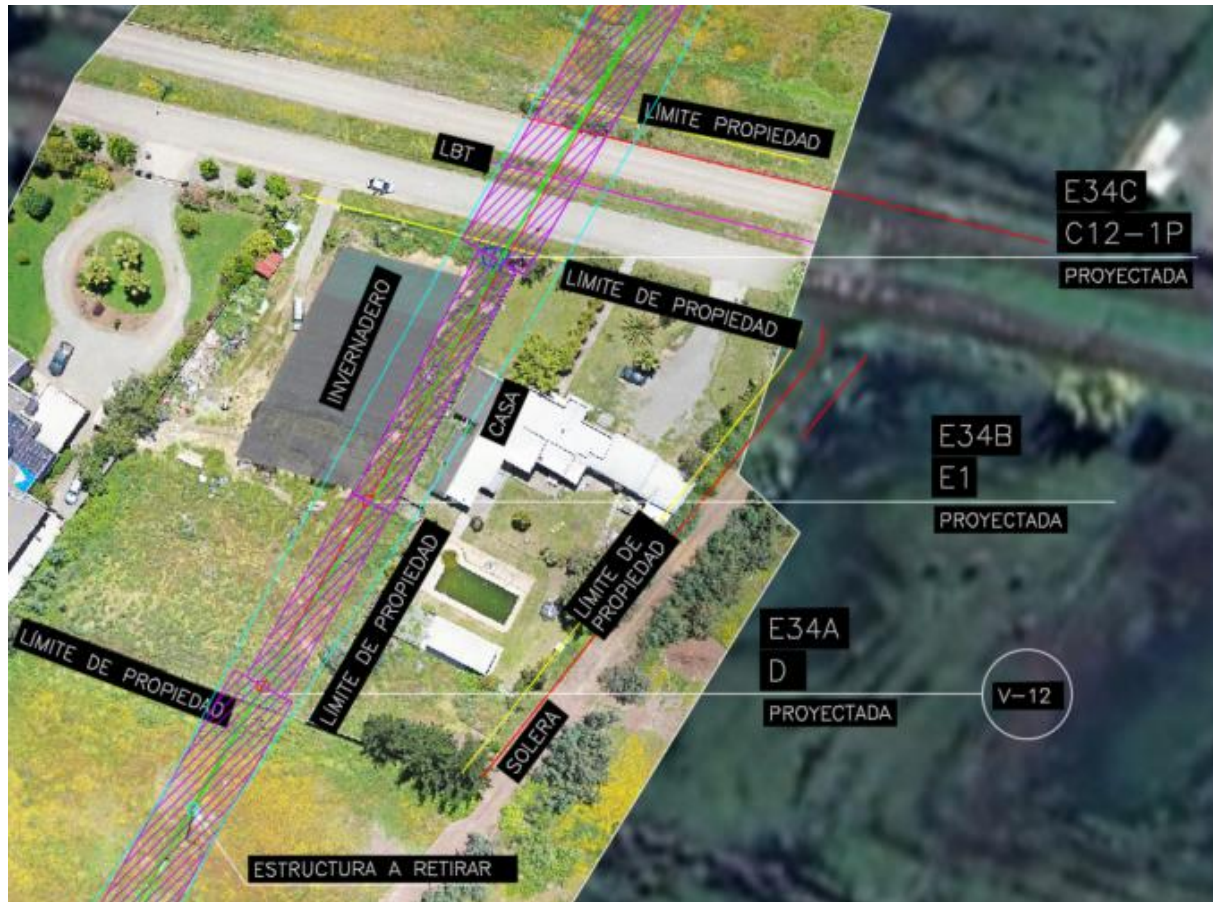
Tramo entre E33 – E35 (proyectado)
